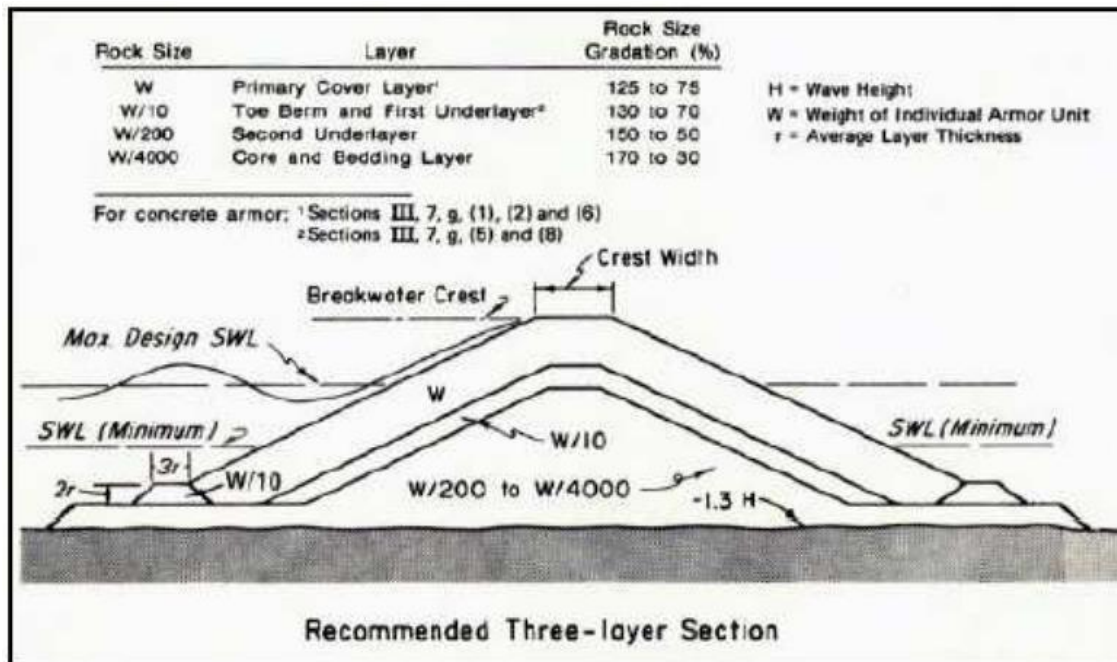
Sección tipo diques de escollera en condiciones de rotura de ola. Fuente Shore Protection Manual
